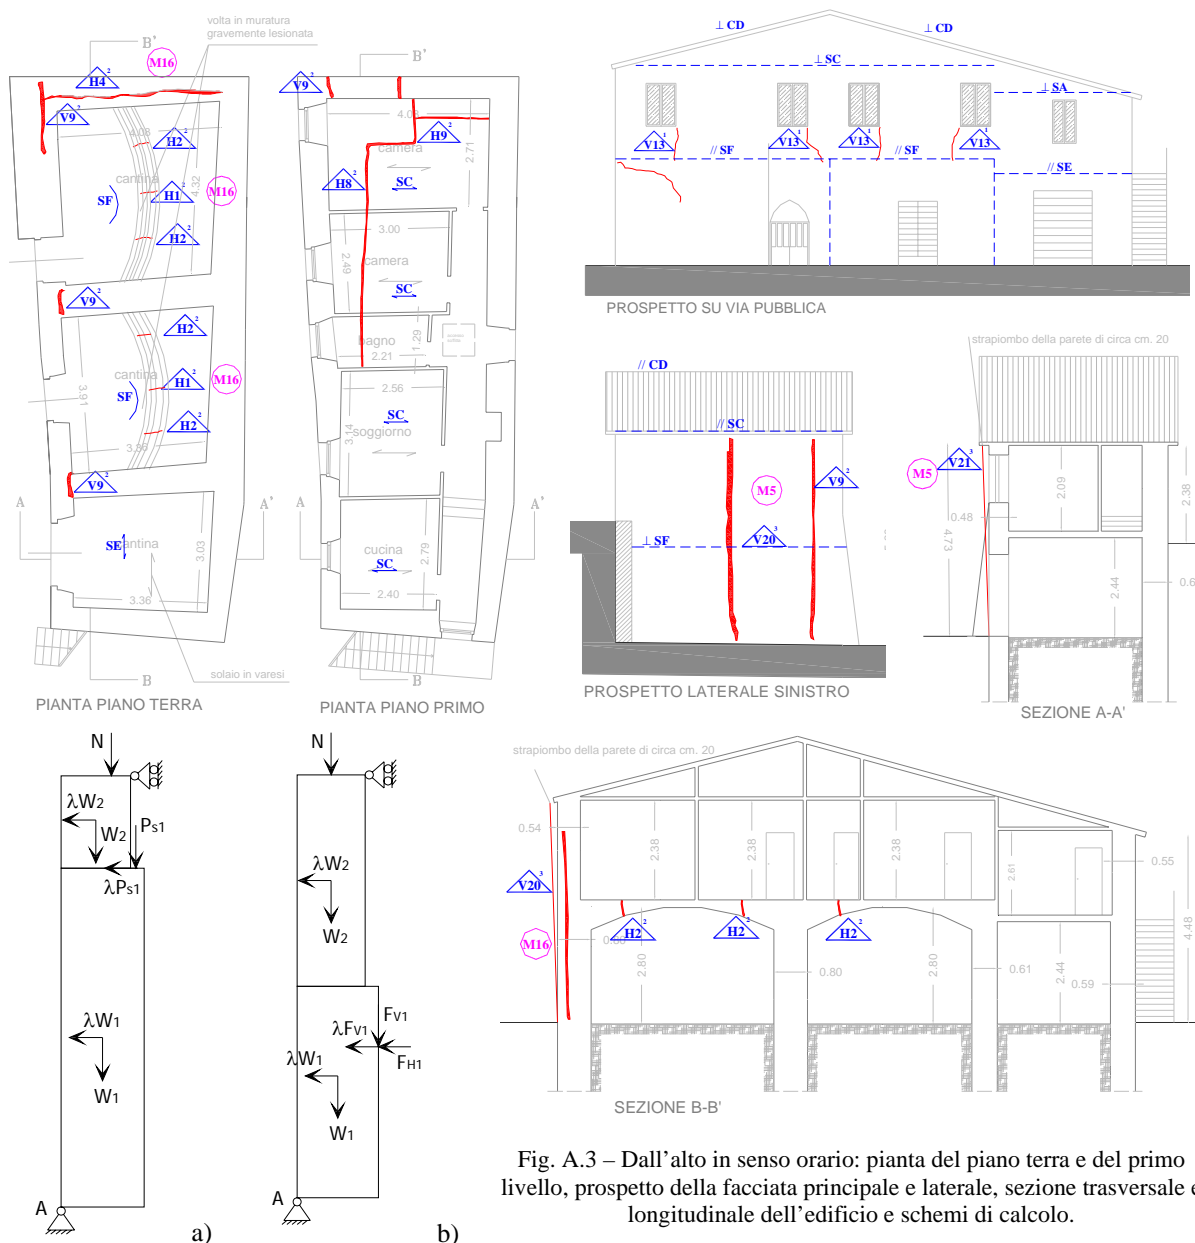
Dall'alto in senso orario: pianta del piano terra e del primo livello, prospetto della facciata principale e laterale, sezione trasversale e longitudinale dell'edificio e schemi di calcolo.
